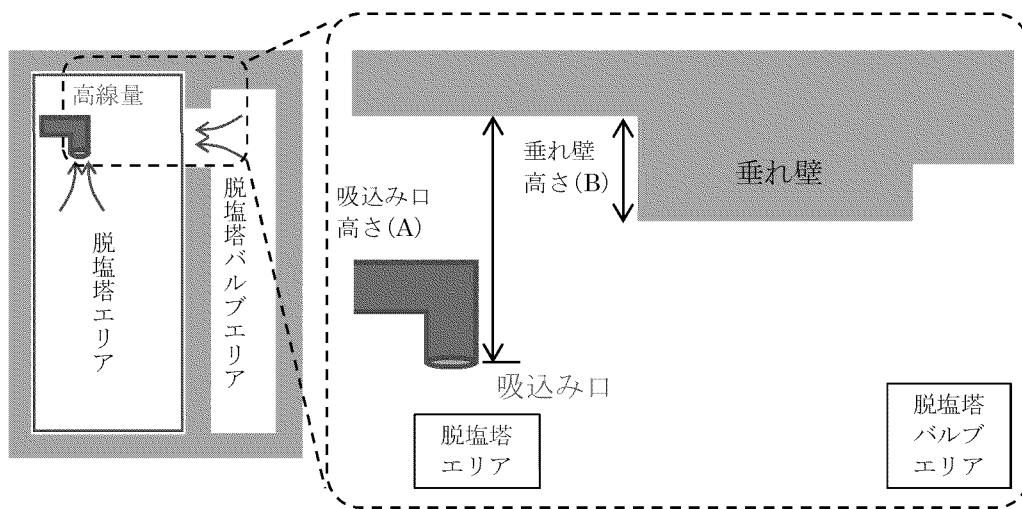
玄海 4 号機 脱塩塔エリアと脱塩塔バルブエリアの配置図（平面図）
